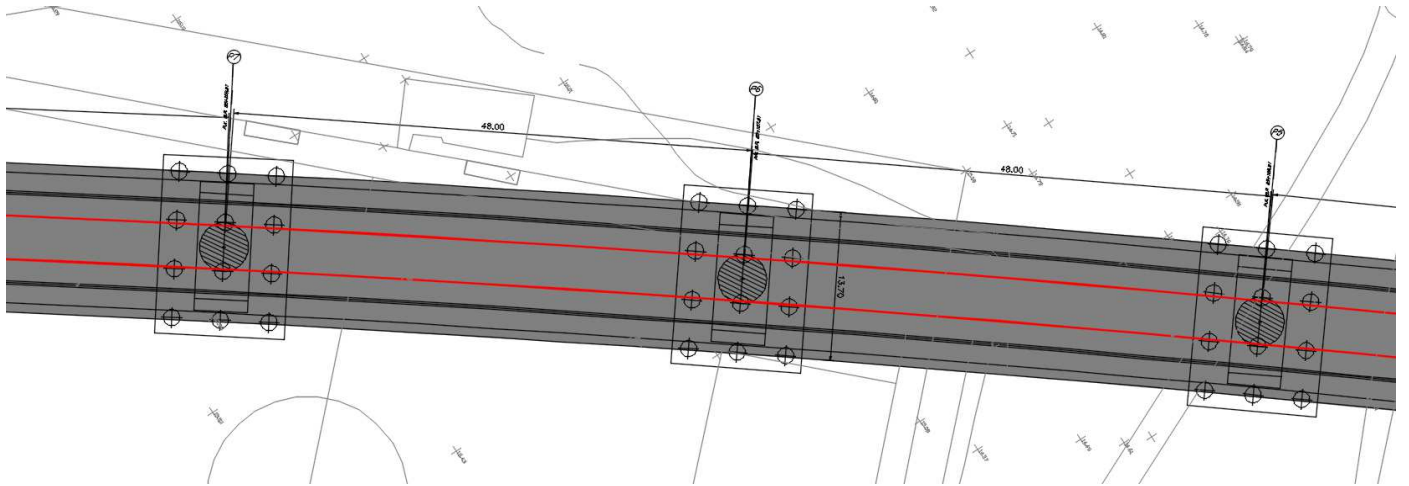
planimetria generale tra spalla B e Pila 8
